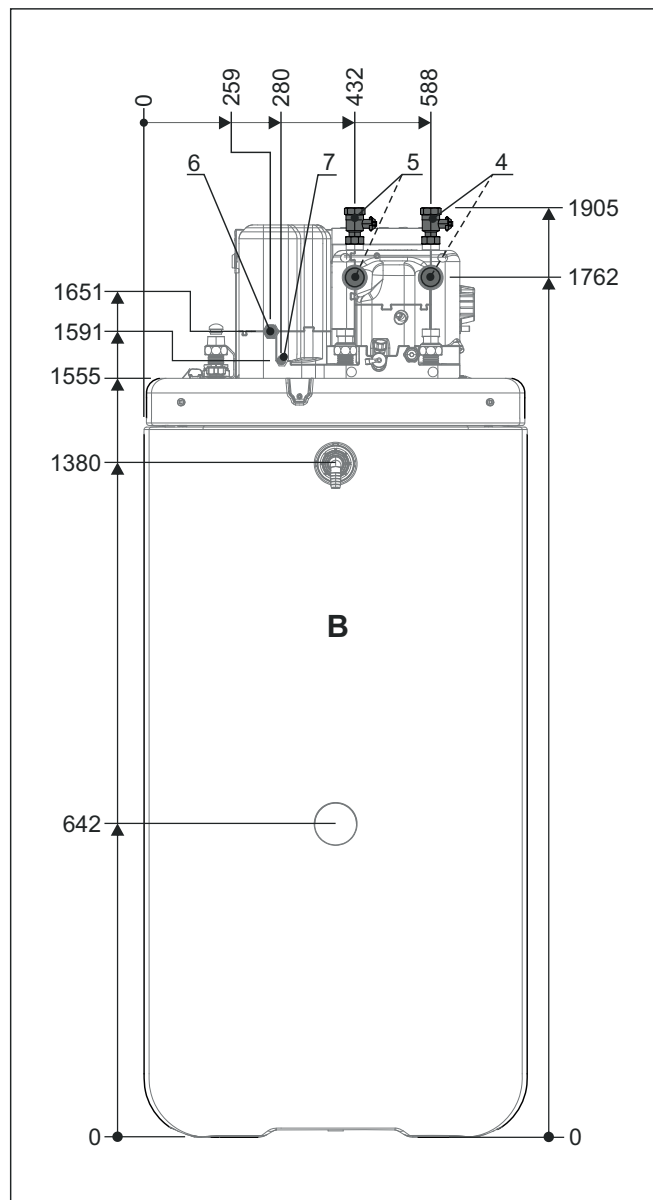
Dimensioni vista laterale - Tipo ...04P50D/...08P50D
